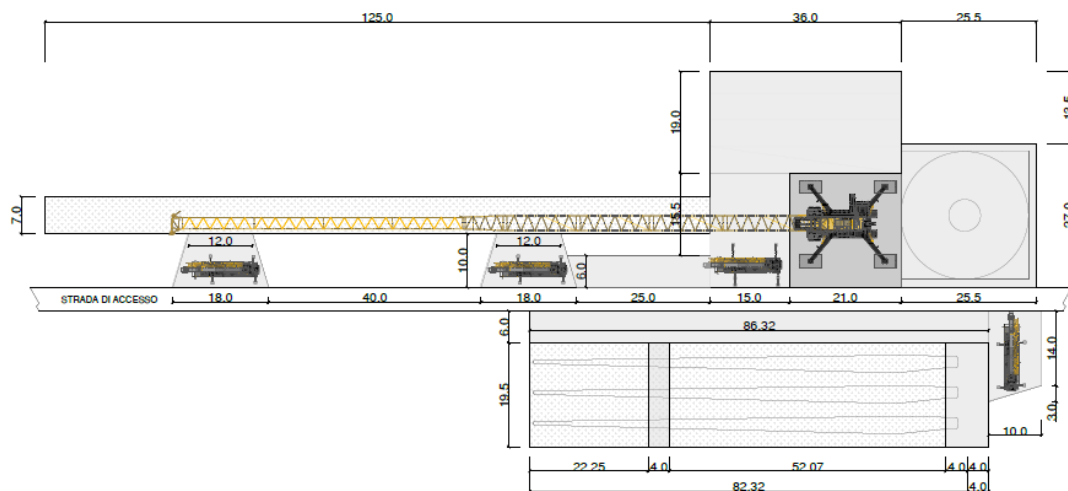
Planimetria piazzola (configurazione completa) in fase di cantiere
